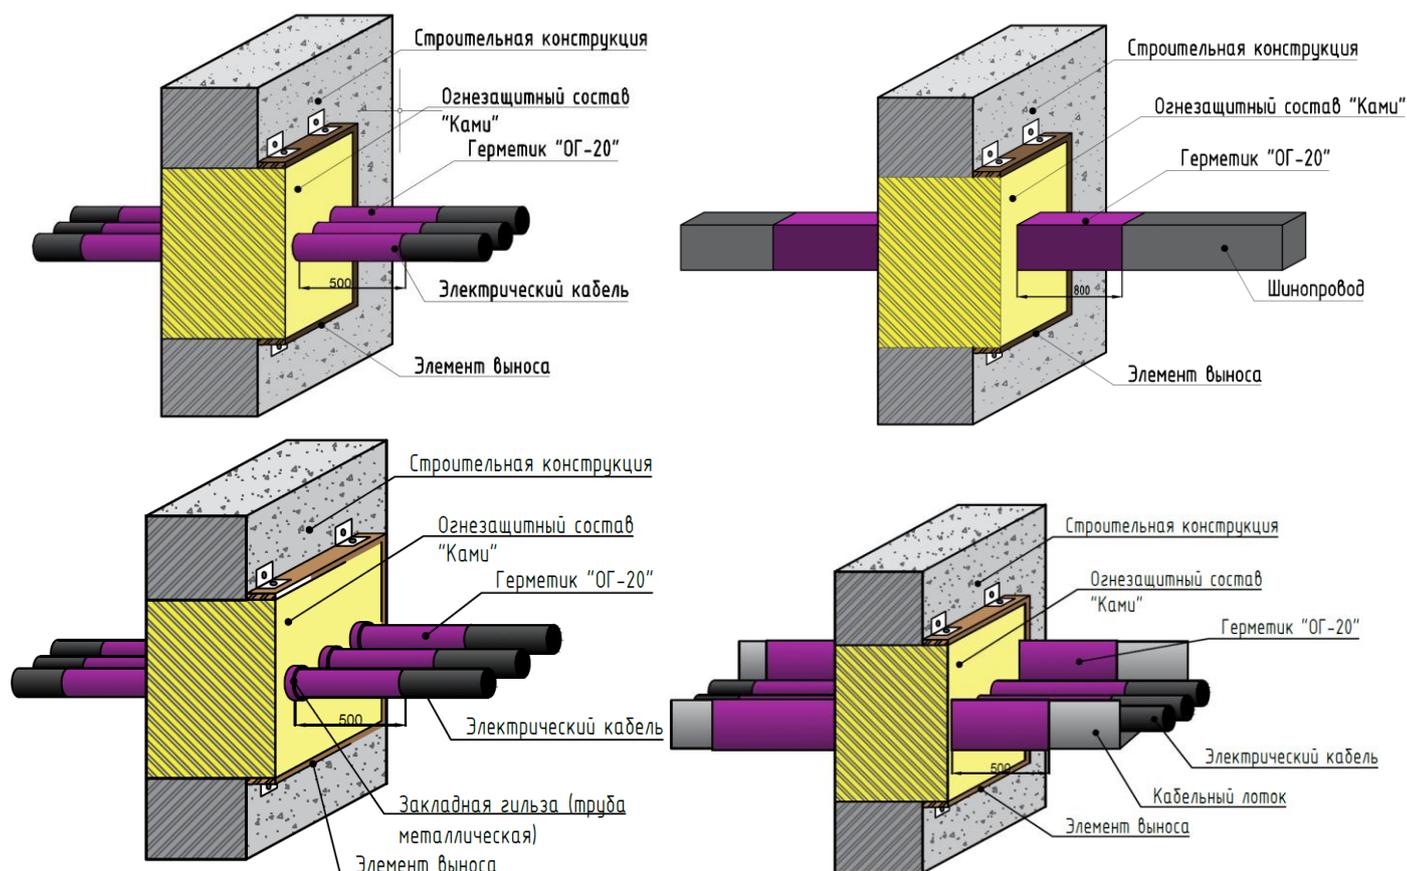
Устройство кабельной проходки «ШТУГЕР» для вертикальных конструкций элементом выноса.
